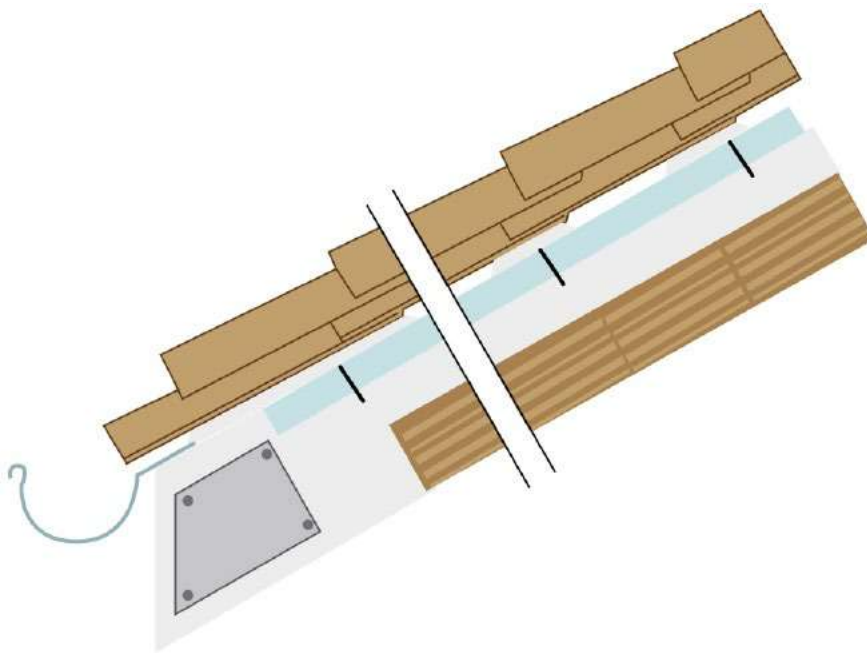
Esquema del sistema de aislamiento térmico de cubiertas inclinadas
